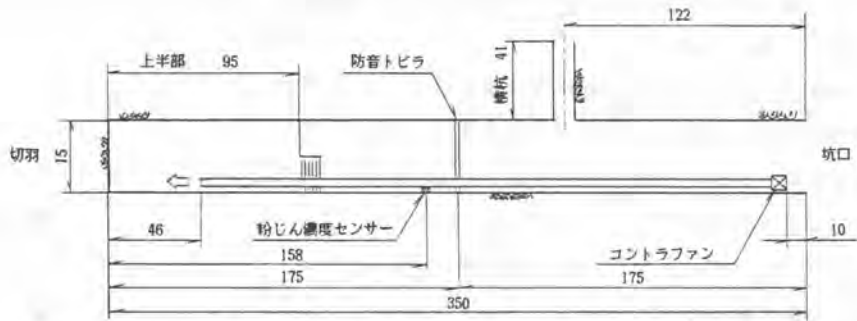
トンネル現況および換気設備の設置状況(平面図 単位:m)
